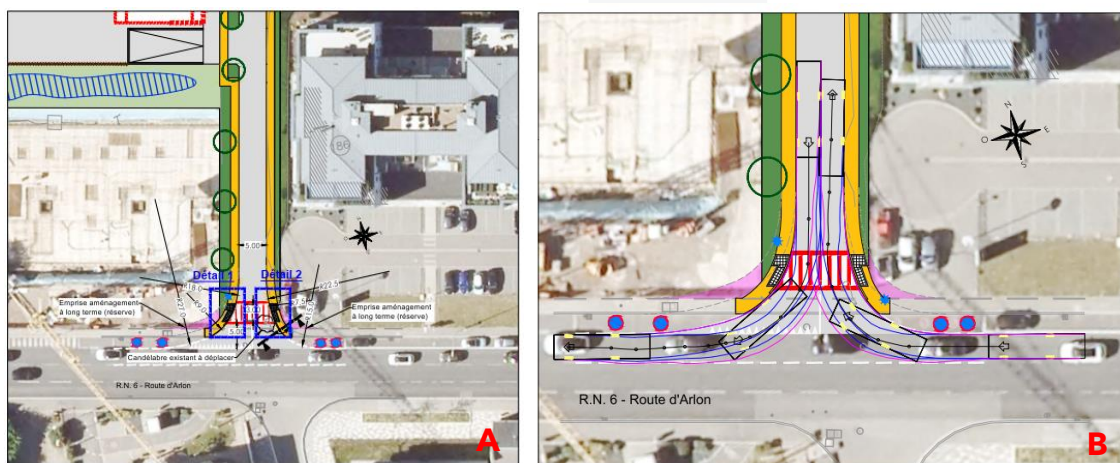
A - plan de situation. B- Giration entrée/sortie sur Route d'Arlon. (Extraits du plan VRD_AUT_PMV-001 - TR-Engineering - 2021)
